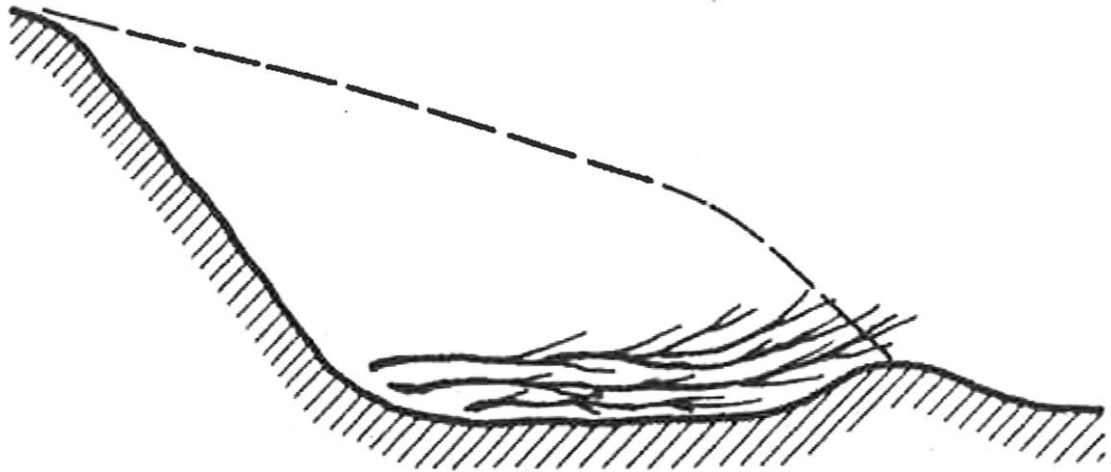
Astlage (Bauvorgang 1, Faschinenwalze)
